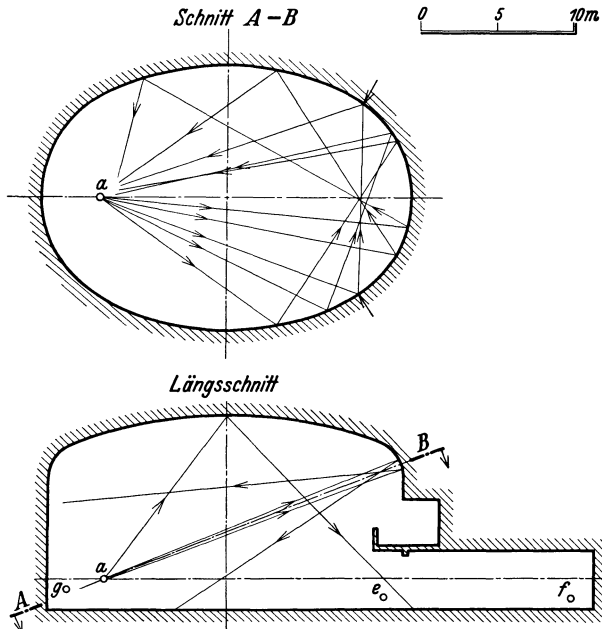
a Längsschnitt, b schräger Schnitt durch die Freiburger Universitätsaula.
